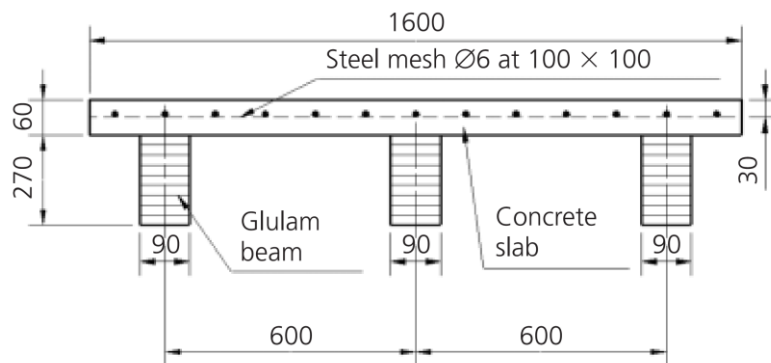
Section transversale des poutres mixtes préfabriquées testées par LUKASZEWSKA (dimensions en mm) [35].
